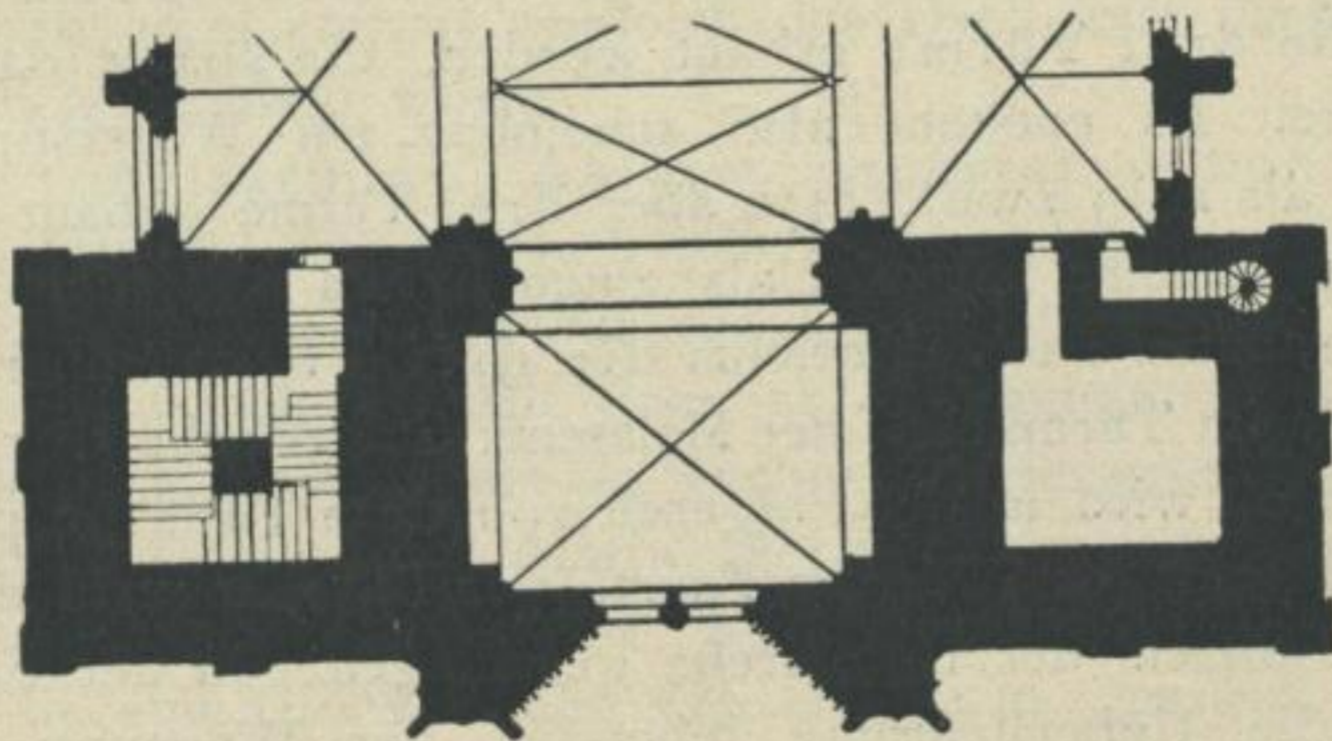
Dom zu Magdeburg. Turm. Grundriss des Erdgeschoss.
